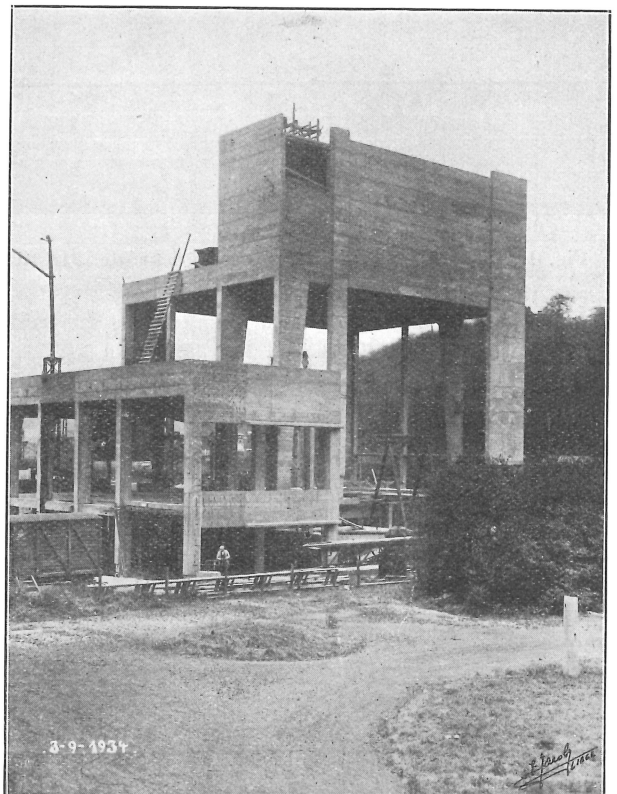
Les portiques en béton armé de la centrale (1934).
